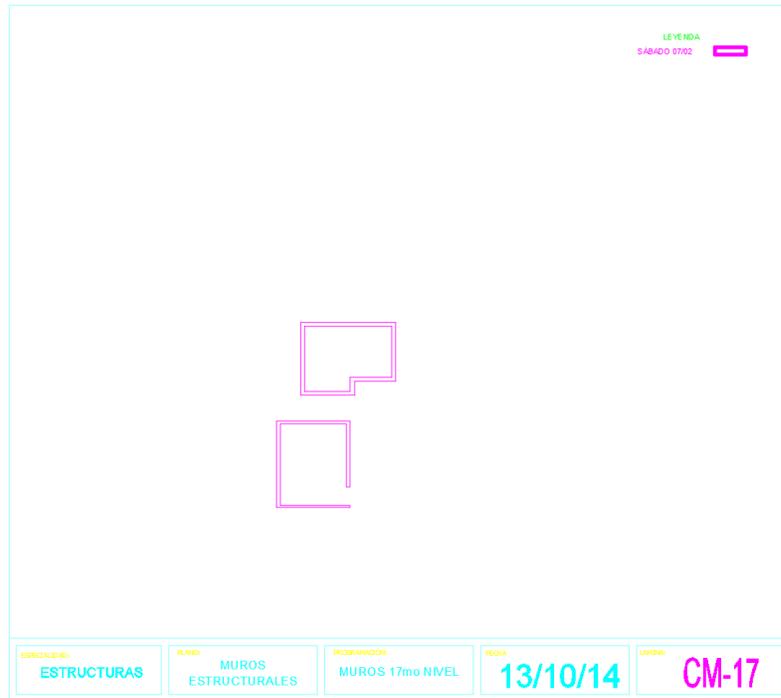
Sectorización de Muros Nivel 17. Fuente: Elaboración Propia
